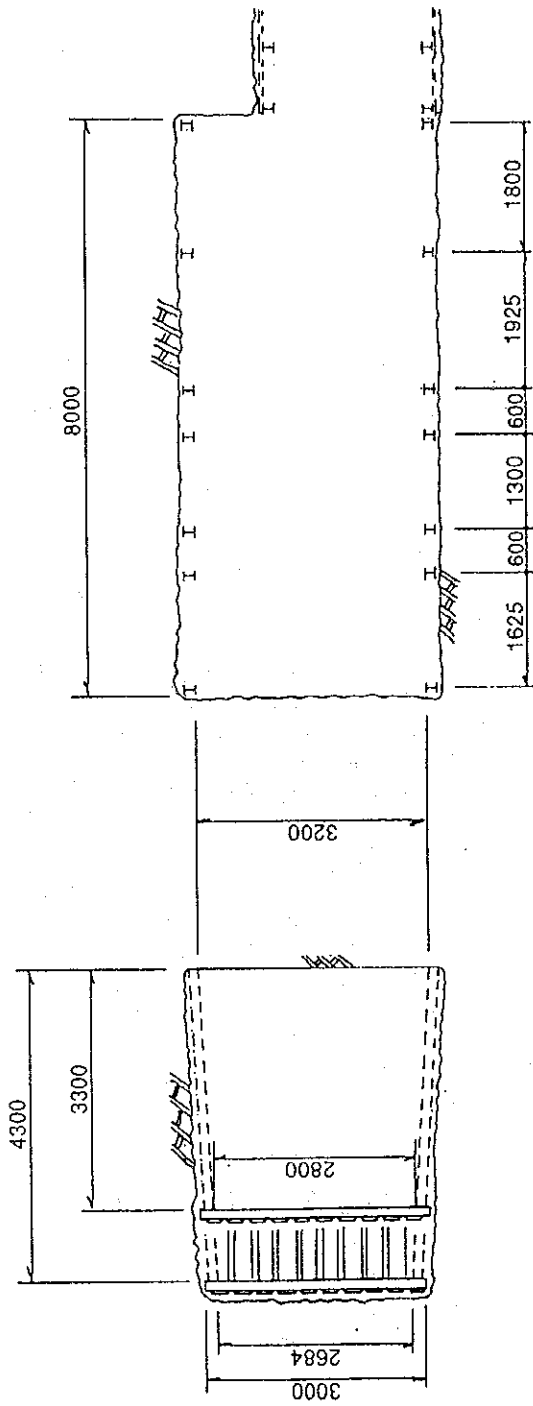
(1) 坑道掘削断面図 (ボーリング室)
